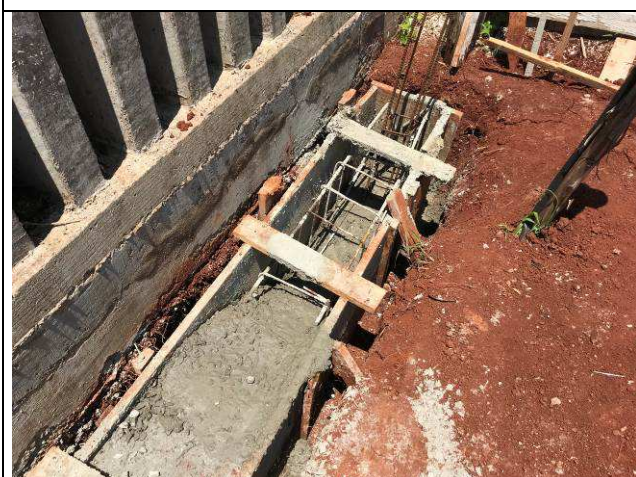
C: Vigas baldrame - muro de fechamento - fundos.
